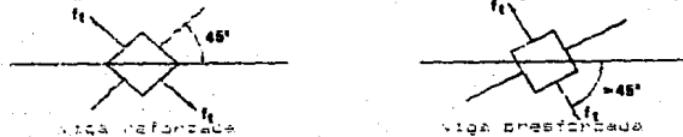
Efecto del prestressing longitudinal en la tensión diagonal y en el endurecimiento. a) Viga reforzada, b) Viga preestirada.
